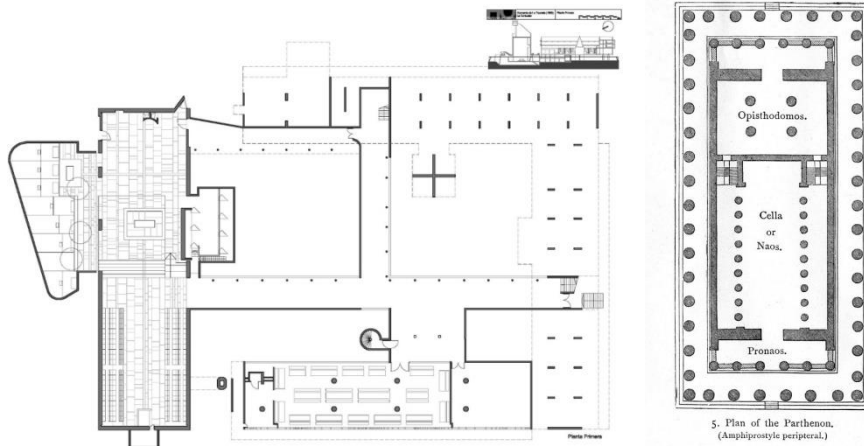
Plan du Couvent de la Tourette (©FLC-Prolitteris)
